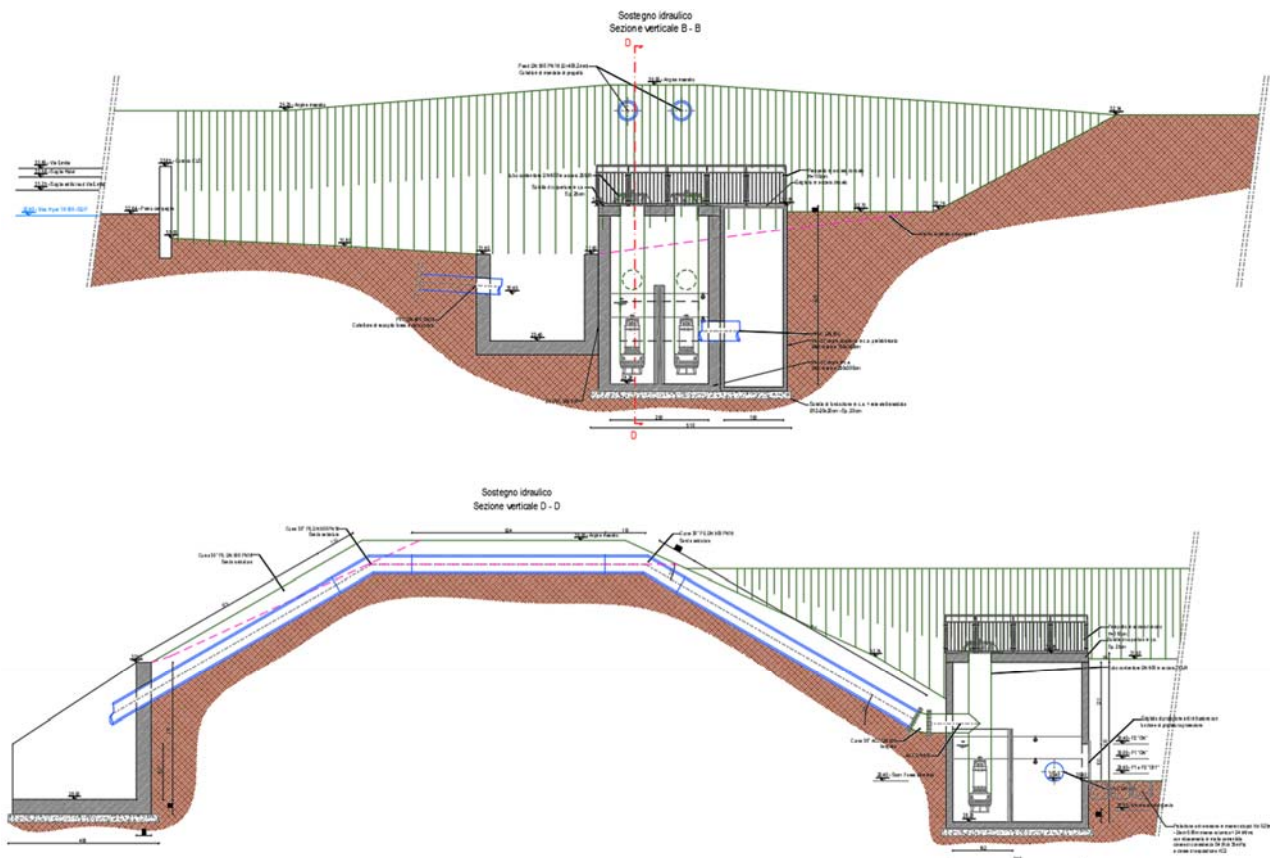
Sezione verticale longitudinale impianto di sollevamento.
